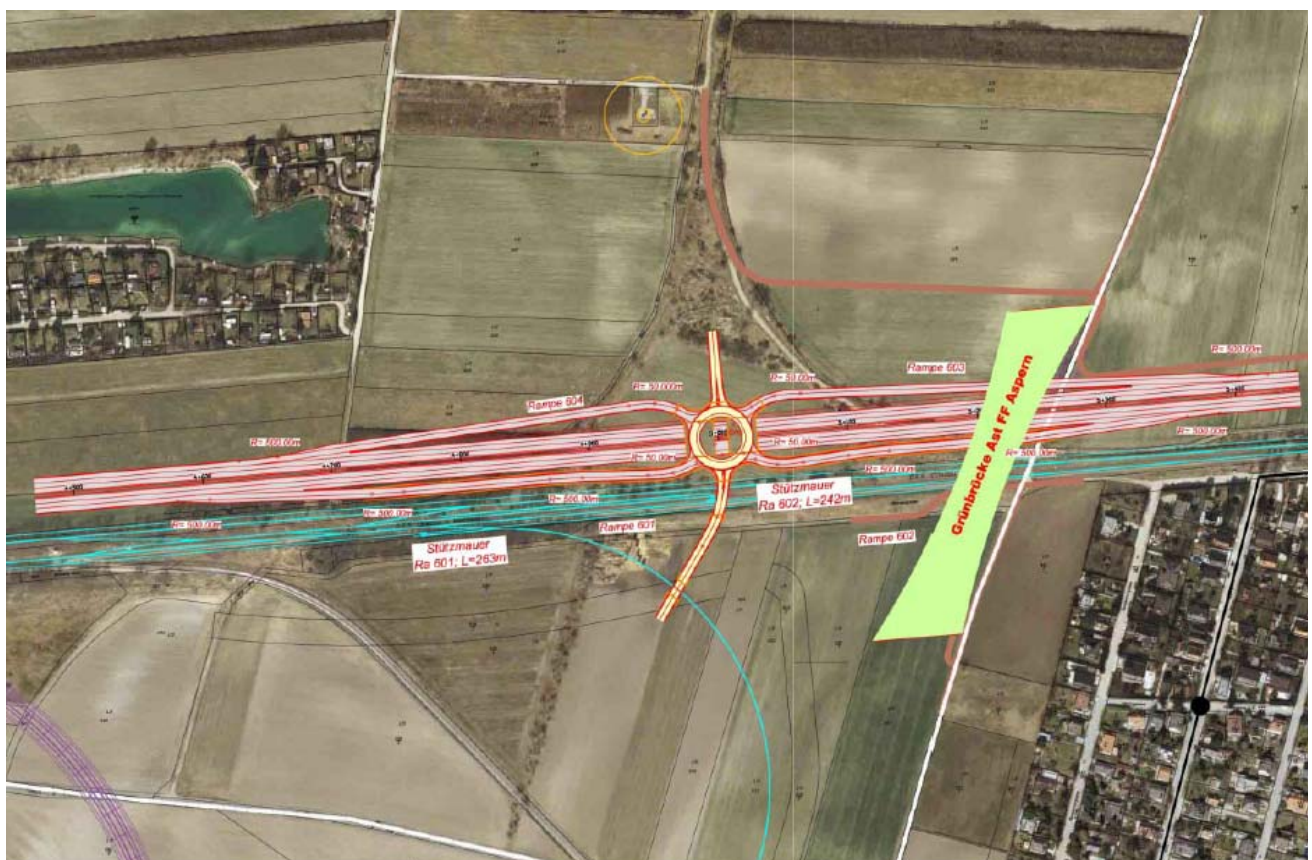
Ausschnitt Lageplan – Technisches Projekt, Einreichprojekt S 1 Spange, Quelle: Werner Consult / IKK
